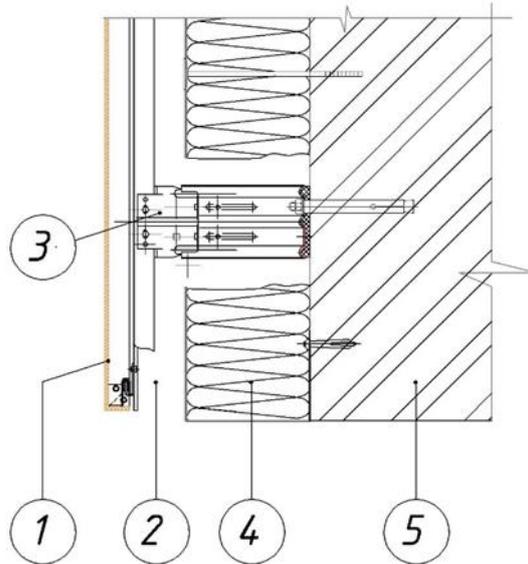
Схема конструкции ограждающей конструкции наружной стены
